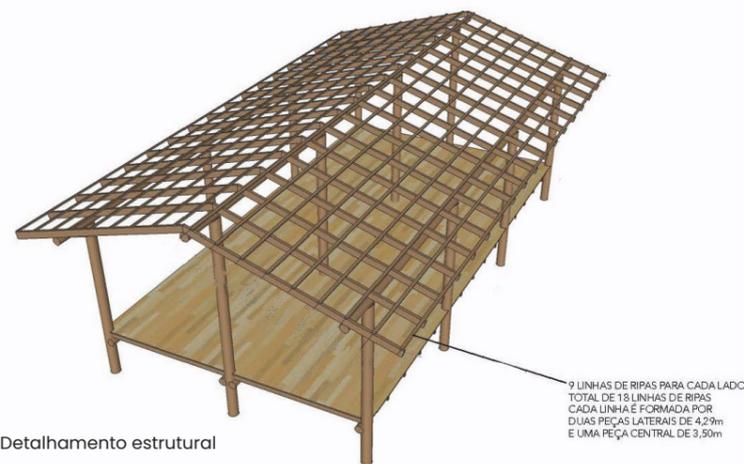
Moradia Guarani em construção - foco para a estruturação do telhado.
